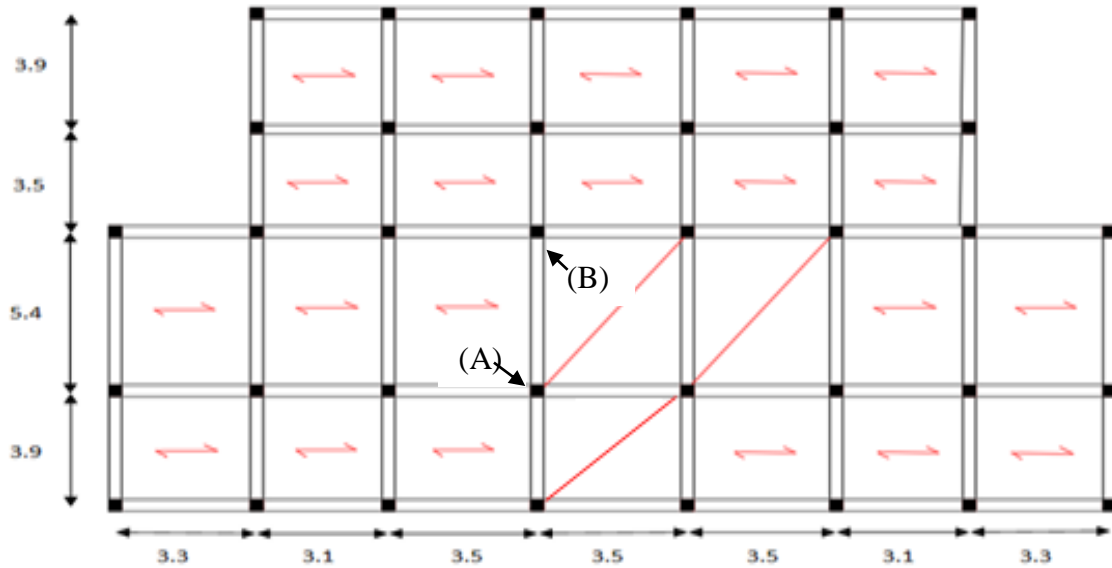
vue en plan d'identification des poteaux de la descente de charge
